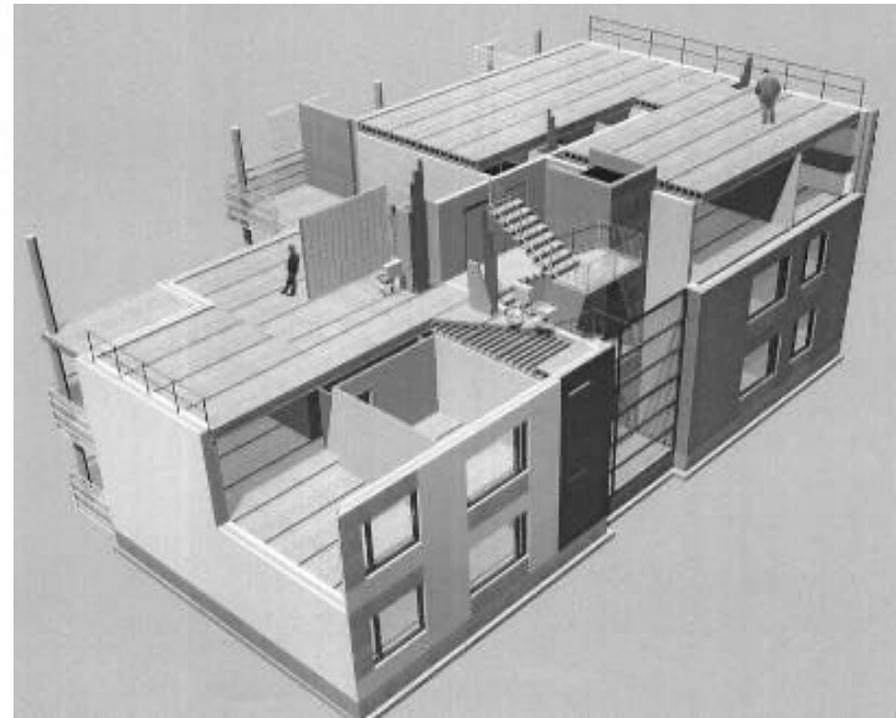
Sistema estrutural com painéis portantes e lajes alveolares protendidas (extraído de Van Acker, 2007)
